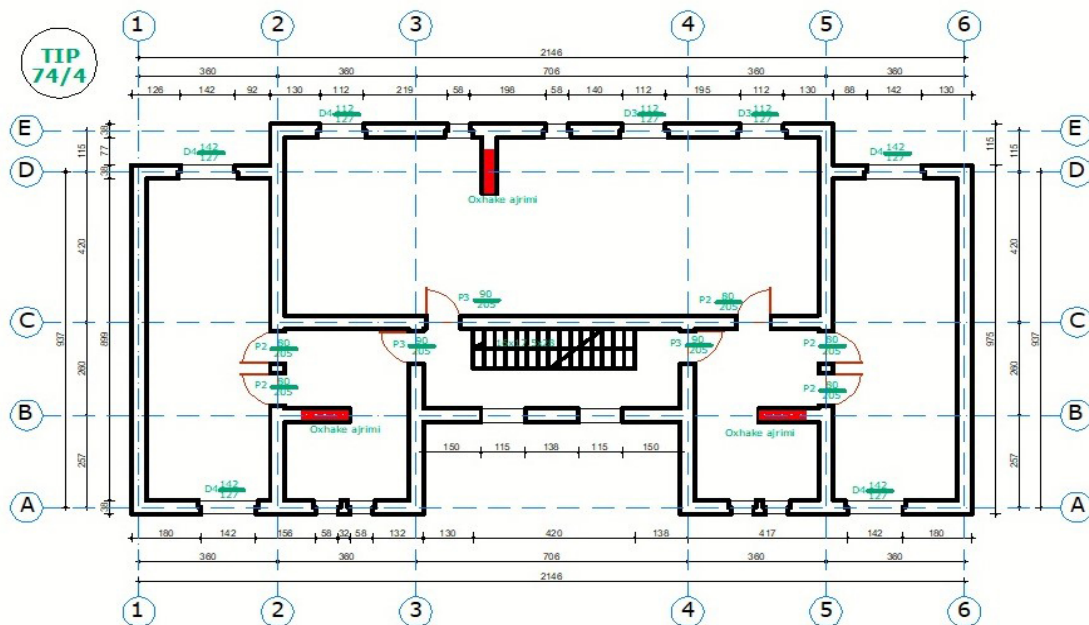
Planimetria e ndërtesës tip 74/4
